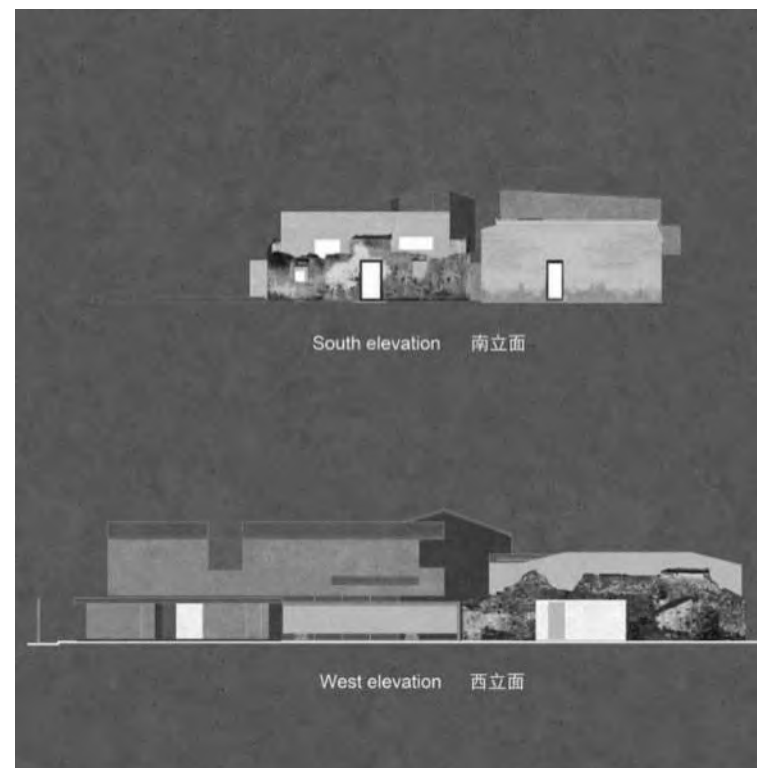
Fachadas Cultural Zhang Yan, Shangai, China. Fuente: Ibidem.
